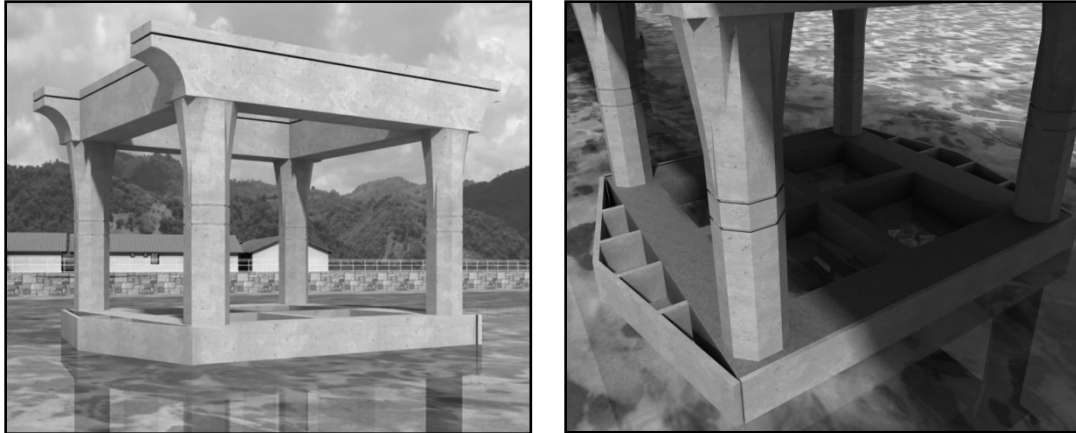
17: Pilas del centro del Puente de Bahía – San Vicente (CEE, 2007)
